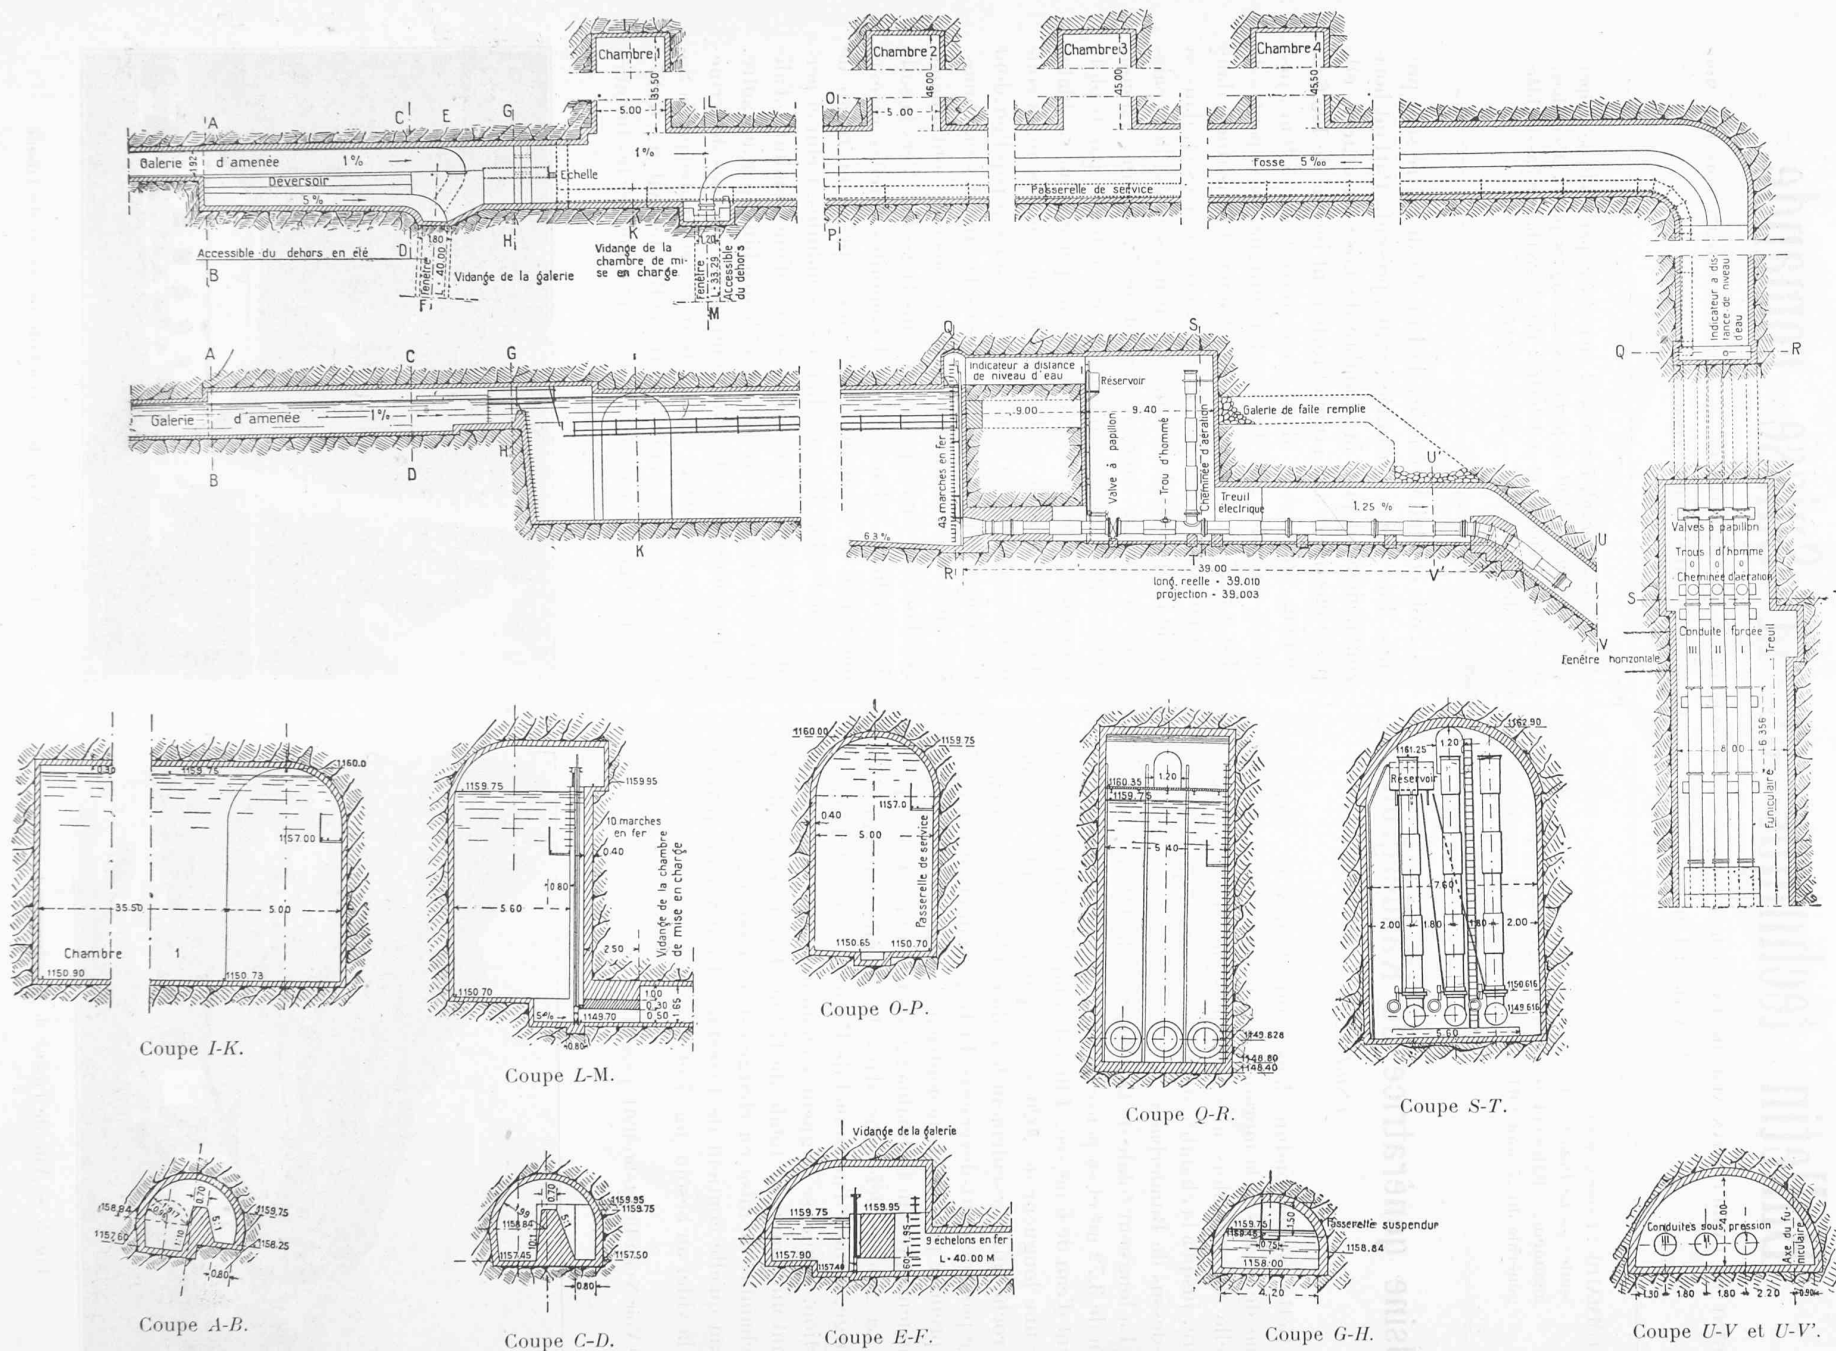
Plan et coupe en long de la galerie d'amenée. — 1 : 500. — Coupes transversales — 1 : 300
